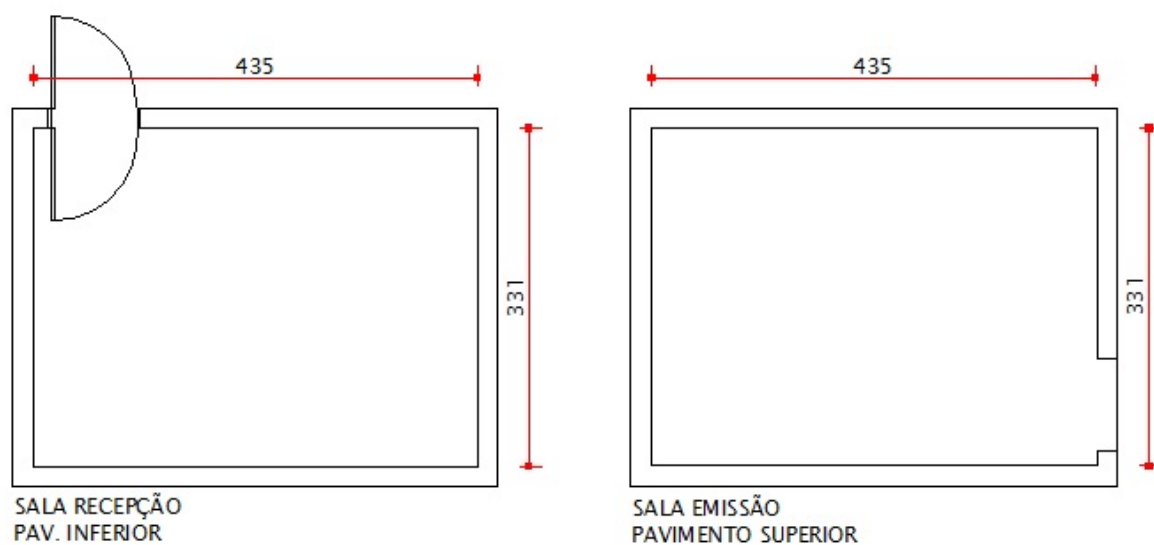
Planta baixa - Câmaras de impacto da UFSM.
